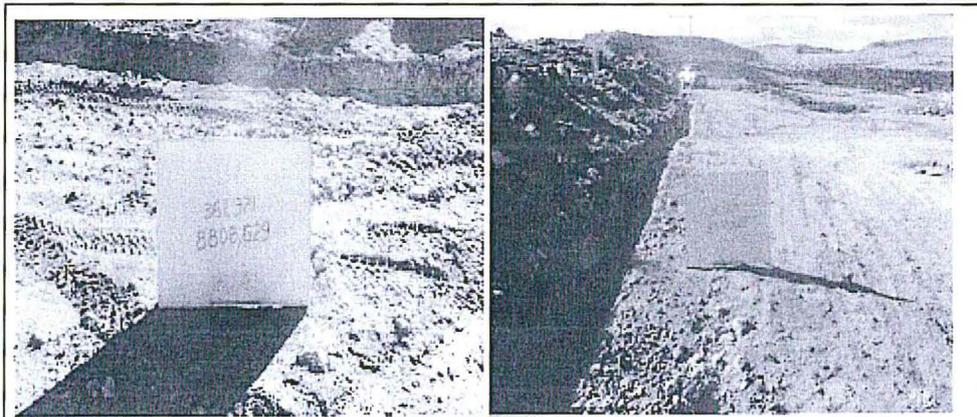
y 20: Vista de cunetas en el acceso a la plataforma de perforación N°41 remediada.
